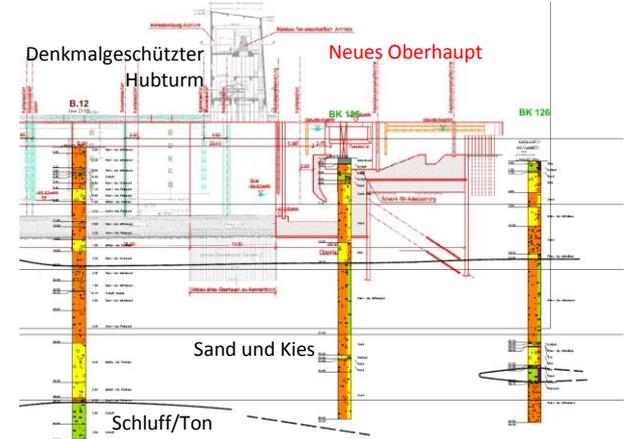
Exemplarische Ergebnisse der Baugrunderkundung
